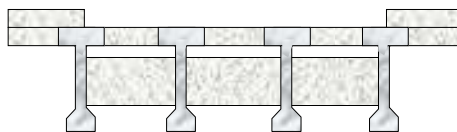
Losa maciza sobre vigas “T” de hormigón pretensado
